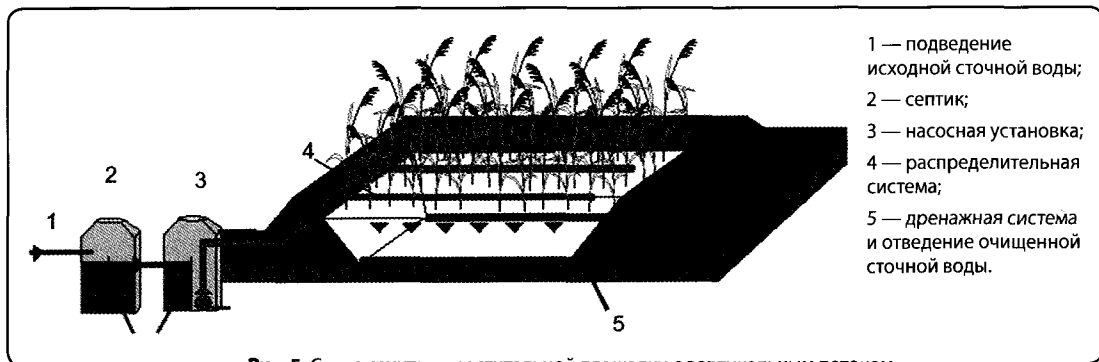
Схема грунтово-растительной площадки с вертикальным потоком
